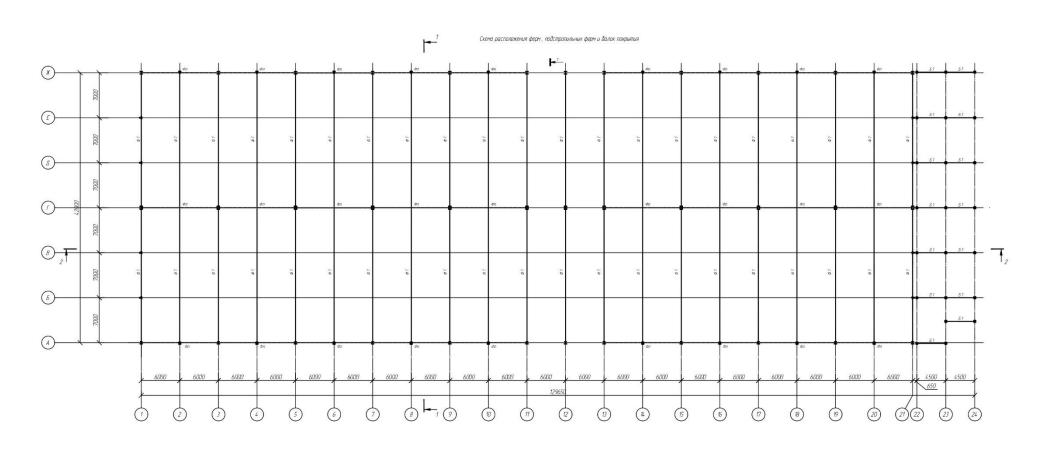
Схема расположения ферм, подстропильных ферм и балок покрытия
